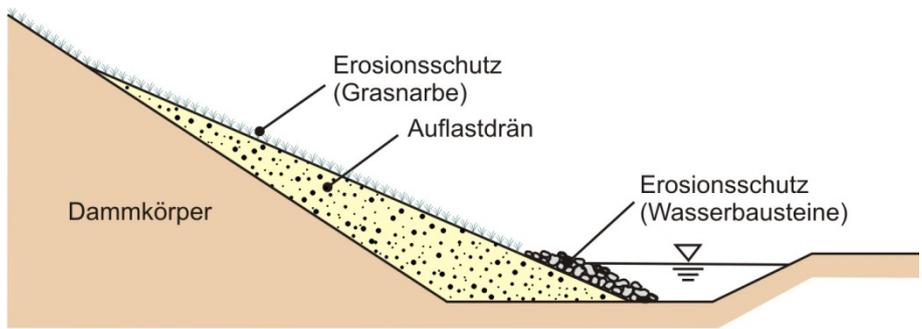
Auflastdrän mit Einstau durch ein Gewässer
